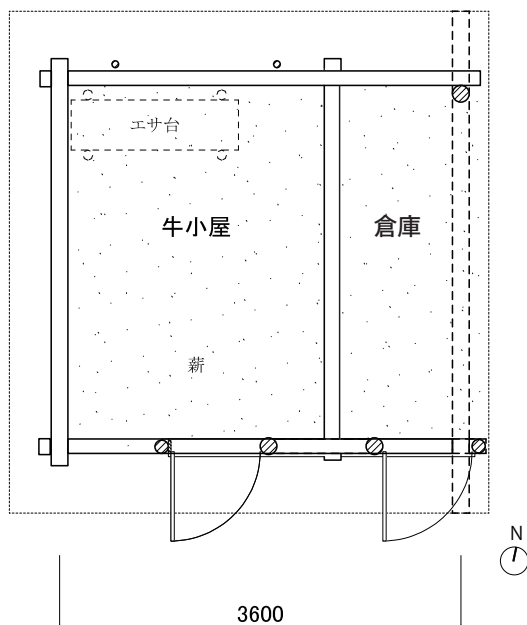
主屋 NO 3 牛小屋と倉庫の平面図
